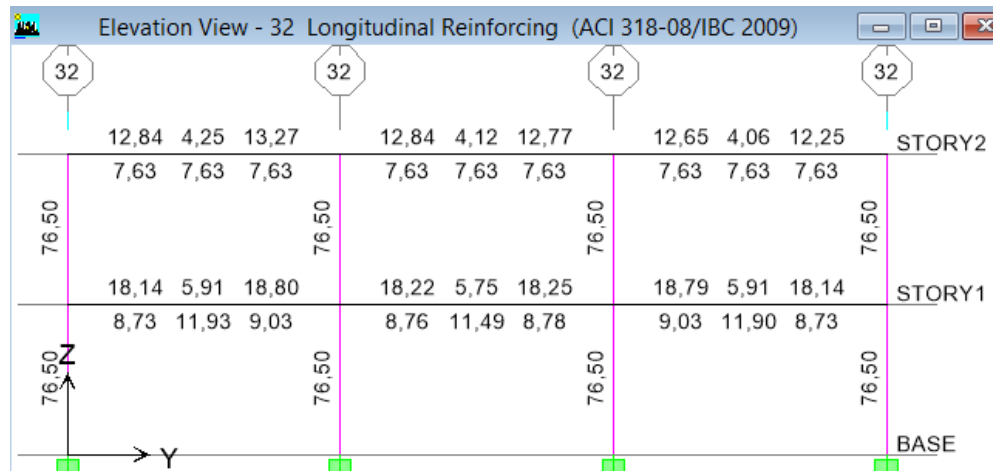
Acero en Vigas y Columnas en el Pórtico 32 – Obstetricia - (CEC2002)
